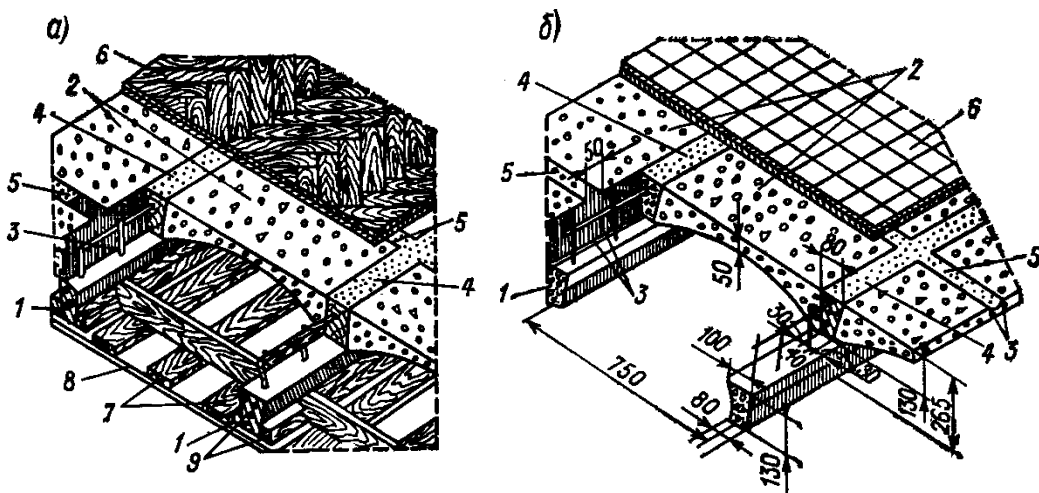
Сборно-монокрипное перекрытие составного сечения конструкции Лаптера
